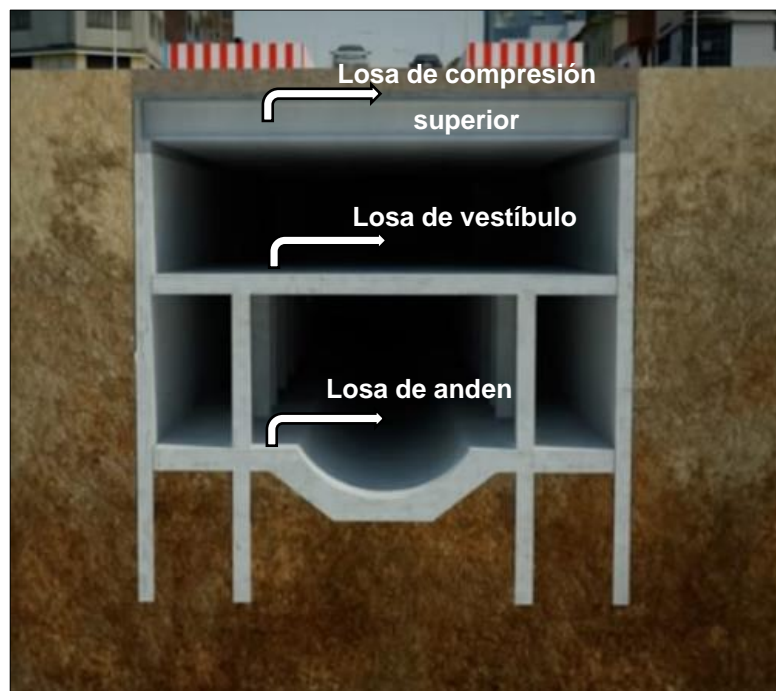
Losa de vestíbulo y viga prefabricada.
